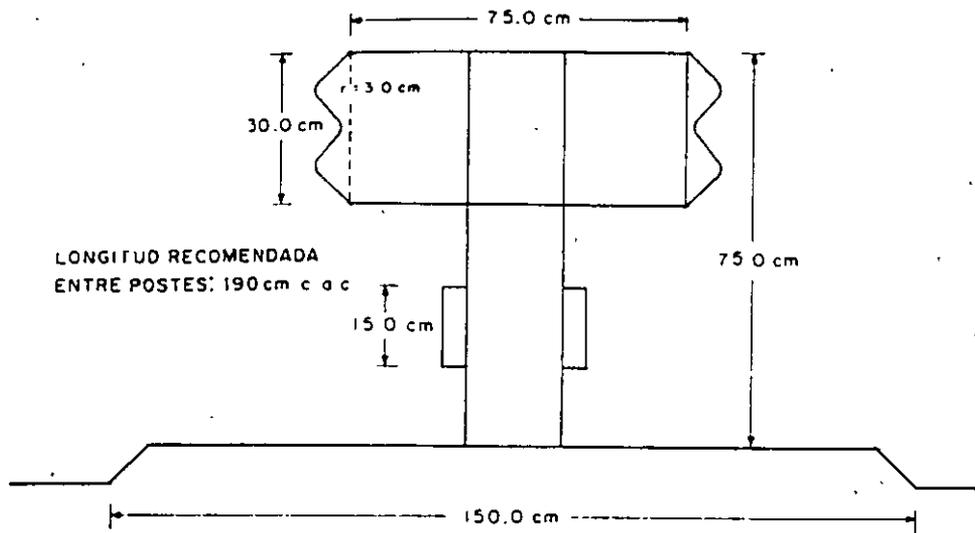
BARRERA RECOMENDADA POR LA DIVISION DE CAMINOS DEL ESTADO DE CALIFORNIA
